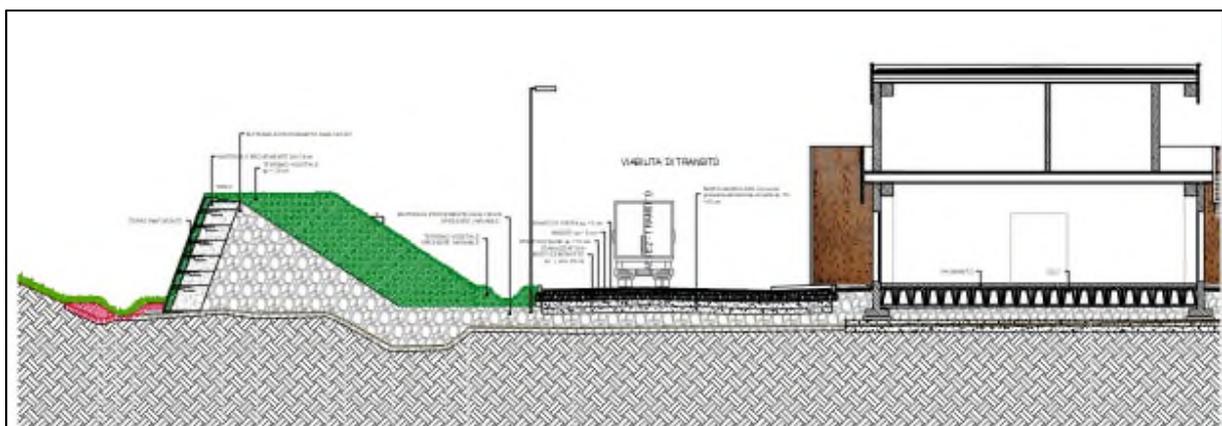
Sezione tipo tratto fabbricato servizi
